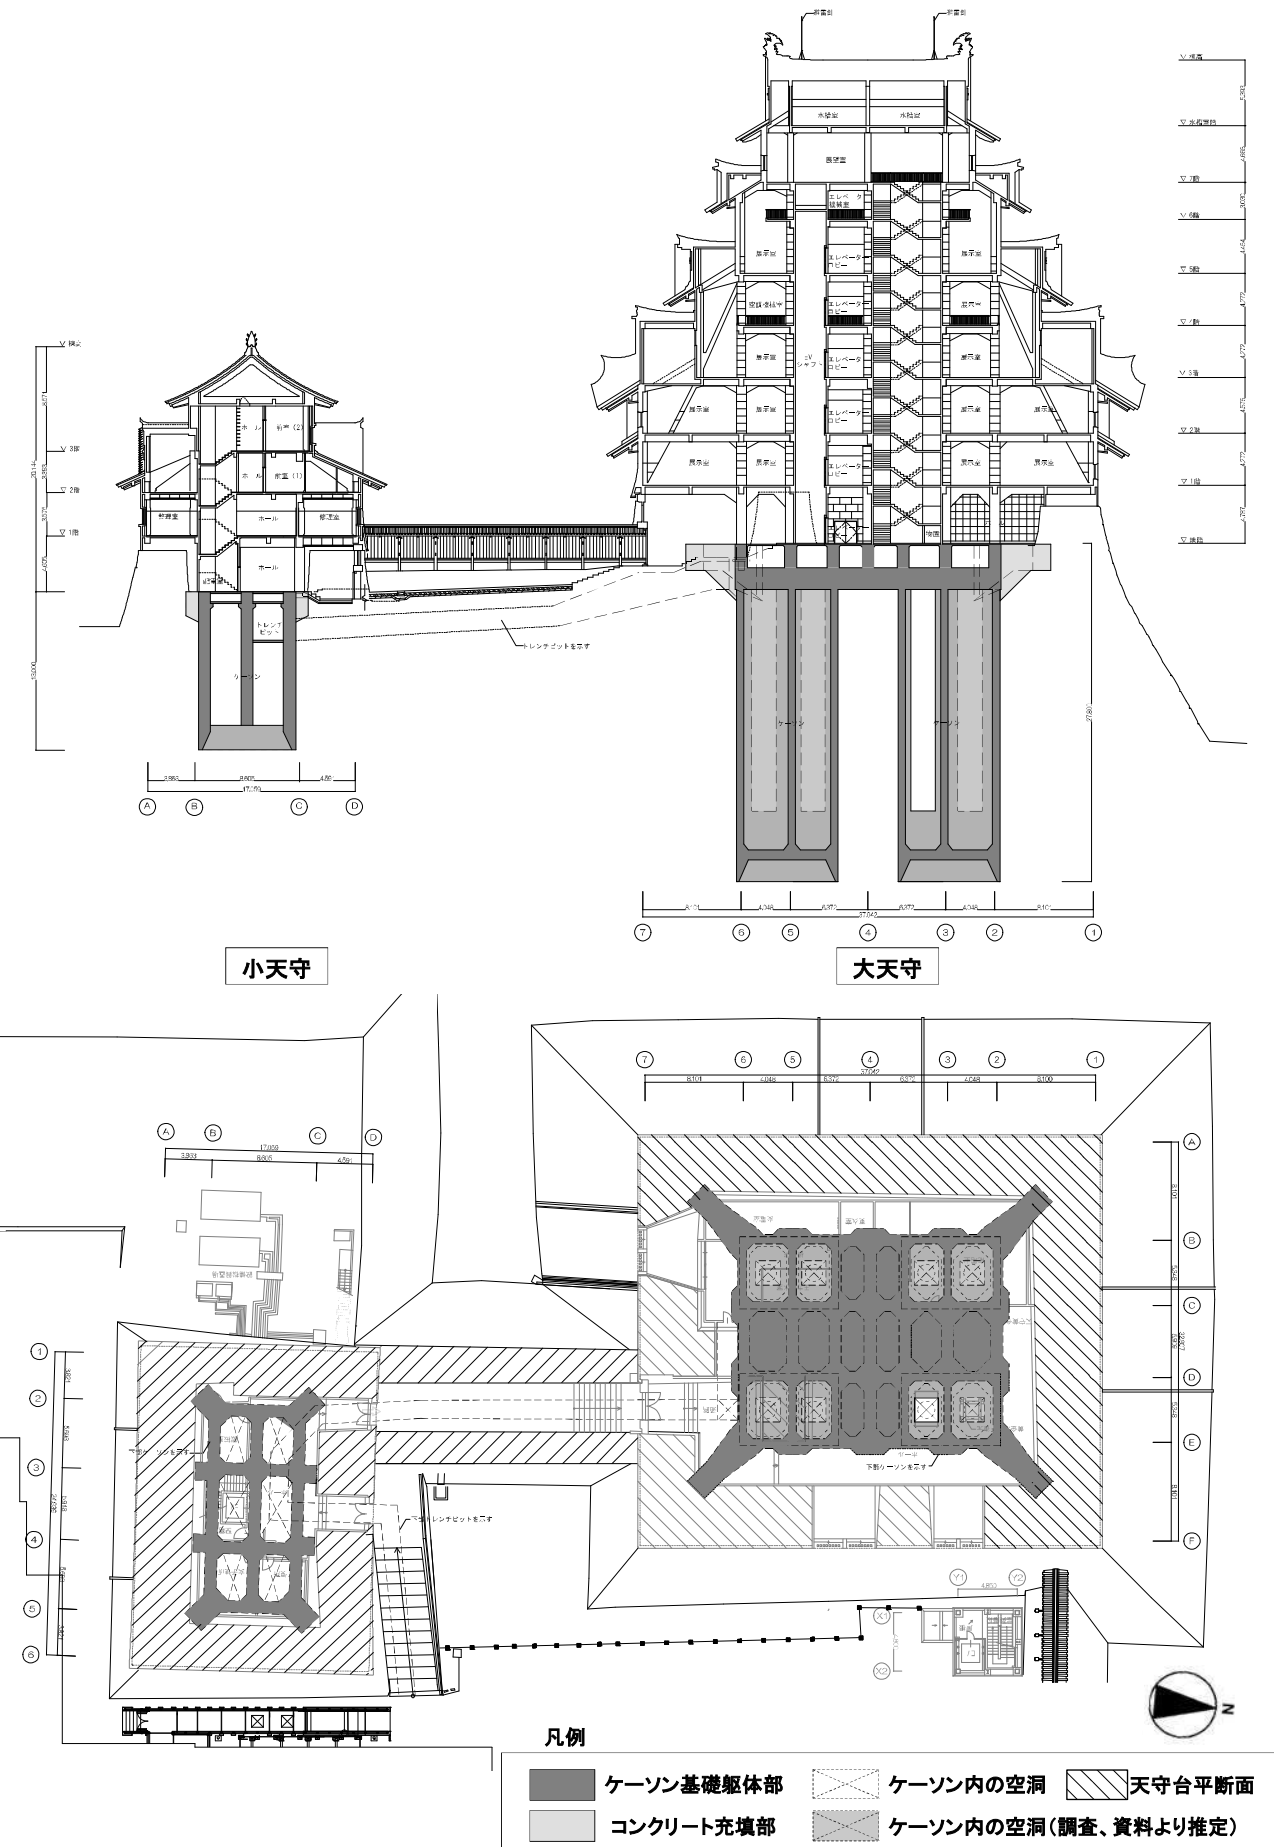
現天守閣ケーソン基礎平面図・断面図
